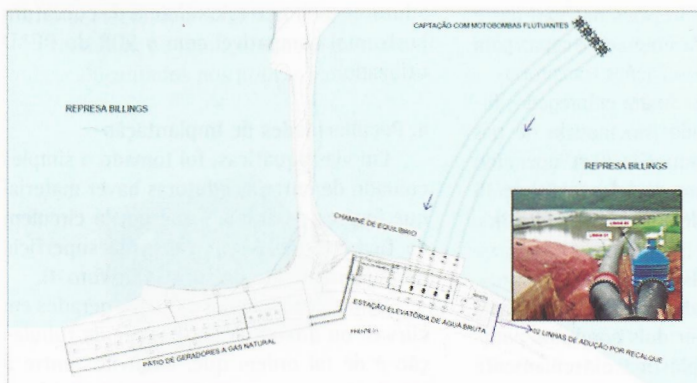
Planta Geral Adaptada, fornecimento Sabesp
